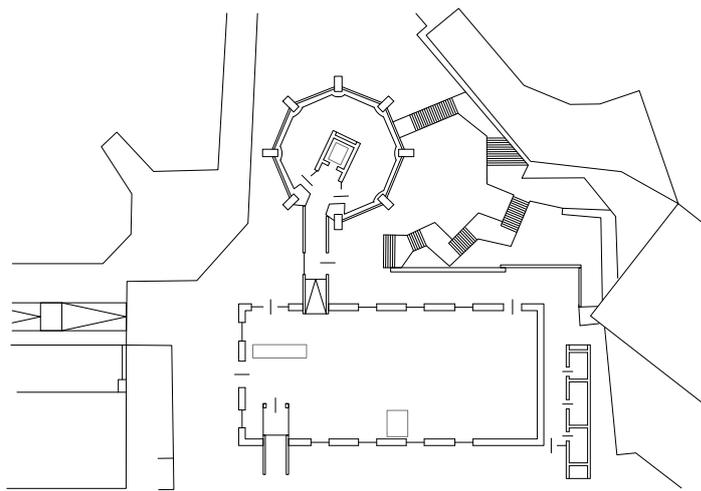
Grundrisse, Wasserturm Düdelingen
